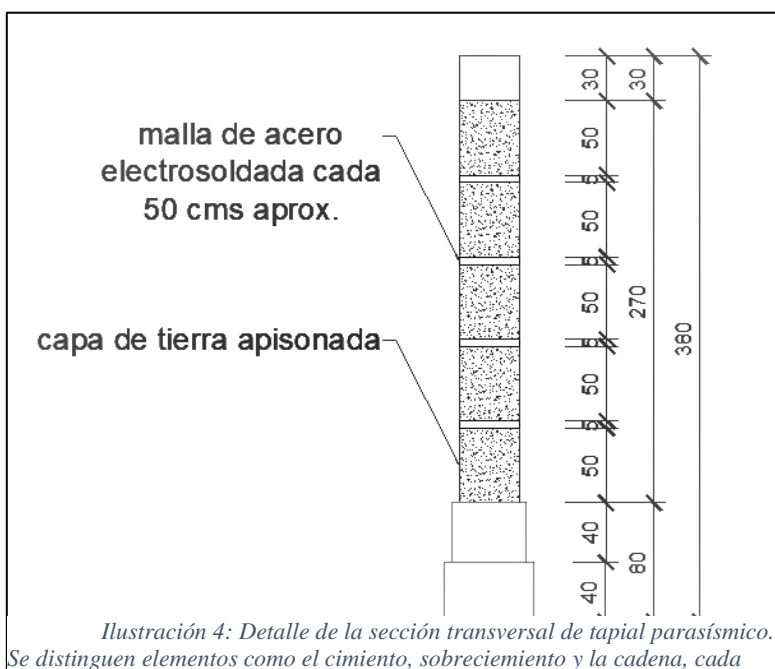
Detalle de la sección transversal de tapial parasísmico. Se distinguen elementos como el cimiento, sobrecimiento y la cadena, cada uno de ellos compuesto por hormigón armado.
